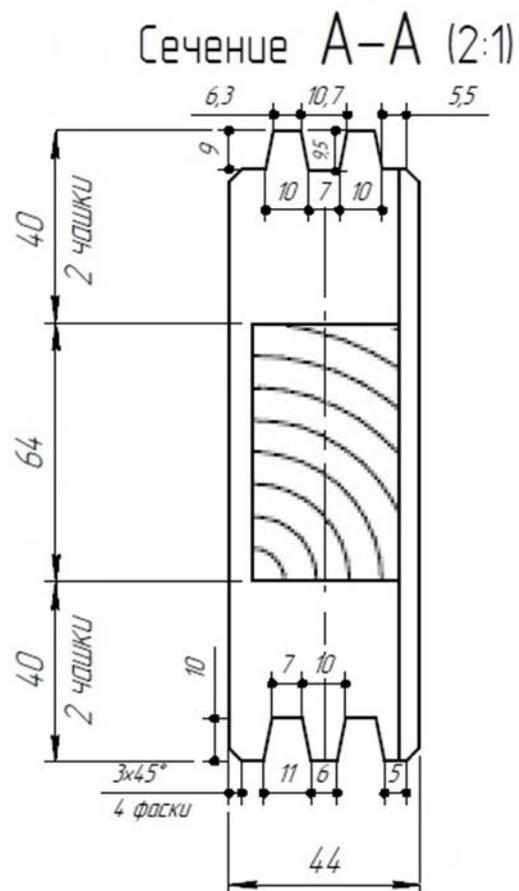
Стандартные размеры сечения деталей стеновых
